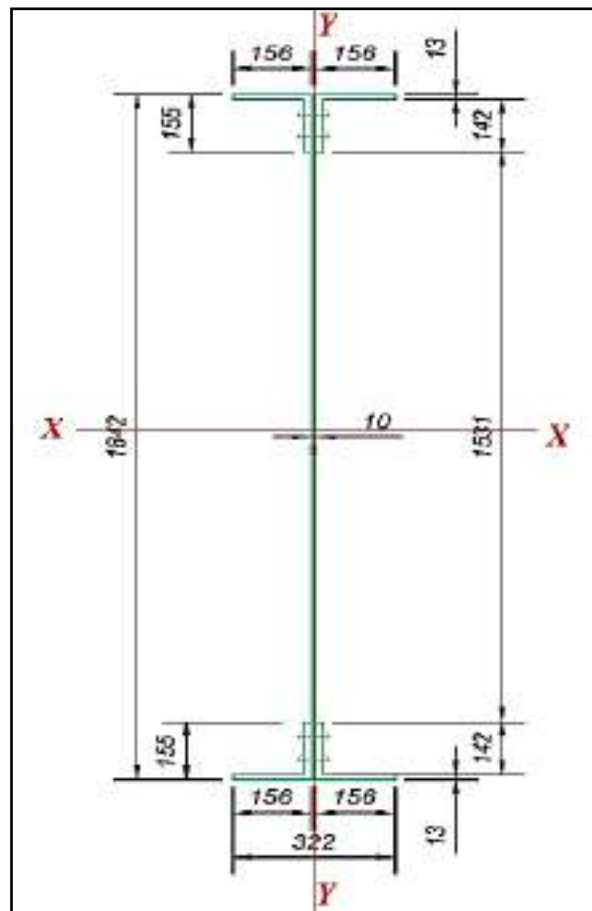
1 Perfil de la viga principal del puente ferroviario Sumbay.
